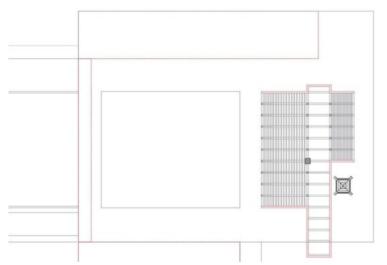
B. Planta de trama pavimentos, Plaza Alta. Fuente: elaboración propia.
